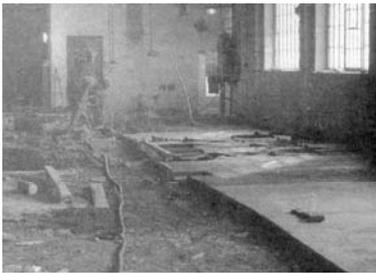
Umbaumaßnahmen Hauptgebäude Seilbahn-Talstation, 14.03.1973 [162]
